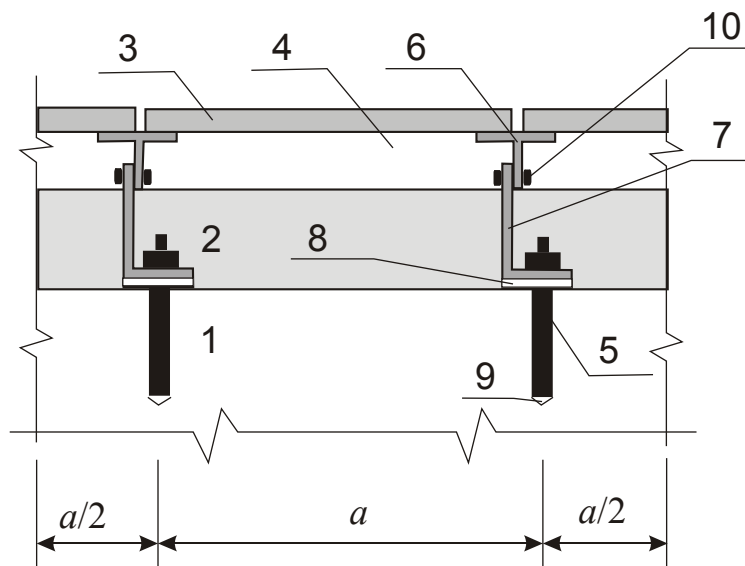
Исследуемая конструкция вентилируемого фасада с вертикальным расположением направляющих:
